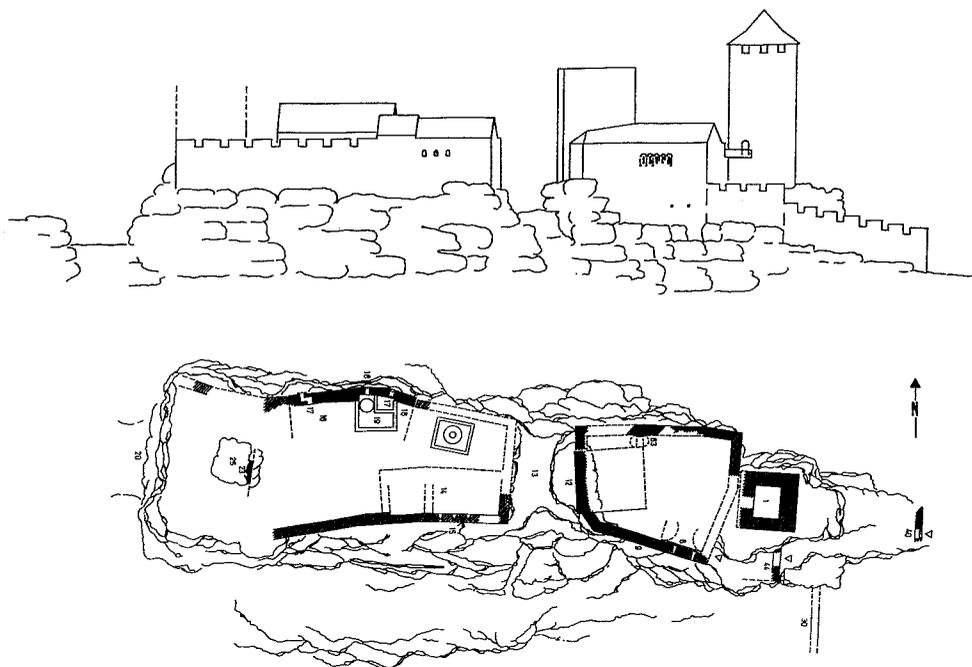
Hohkönigsburg bei Schlettstadt/Sélestat, Rekonstruktionsversuch von Grundriß und Südansicht nach Abschluß der romanischen Phasen (um 1250). Kreuzschraffiert die ältesten Bauteile, Mitte 12. Jahrhundert (Biller unter Verwendung des Grundrisses von B. Ebhardt)
